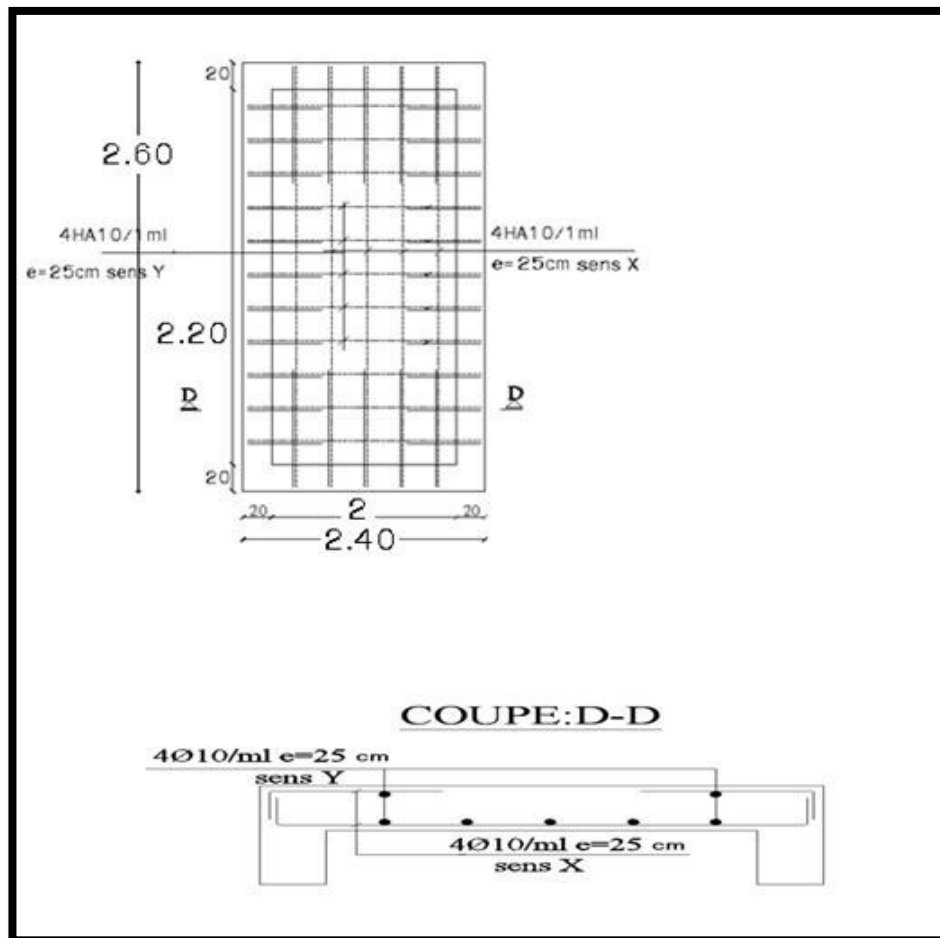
Ferrailage la dalle terrasse de l'ascenseur
